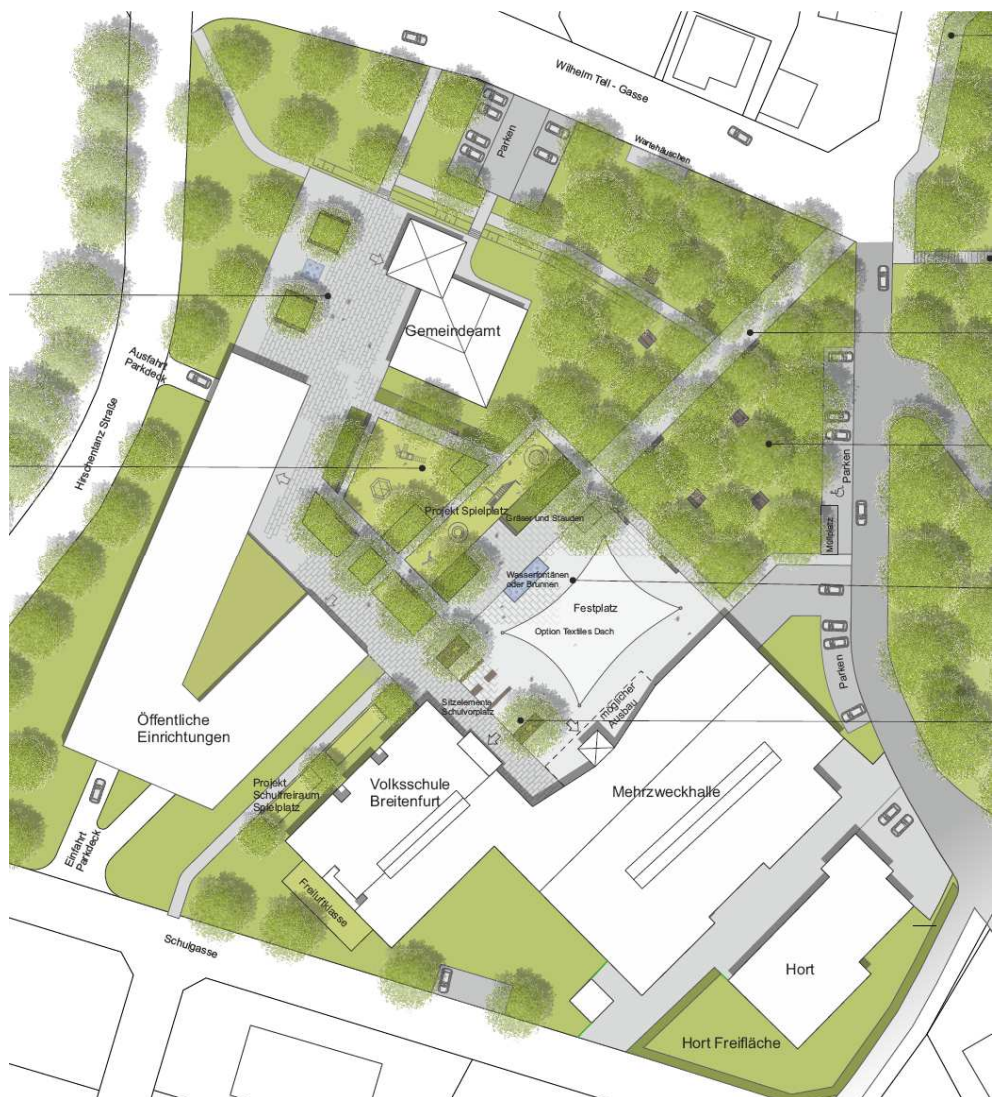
Übersichtsdarstellung Festplatz (Plan im Originalmaßstab siehe Anhang)
